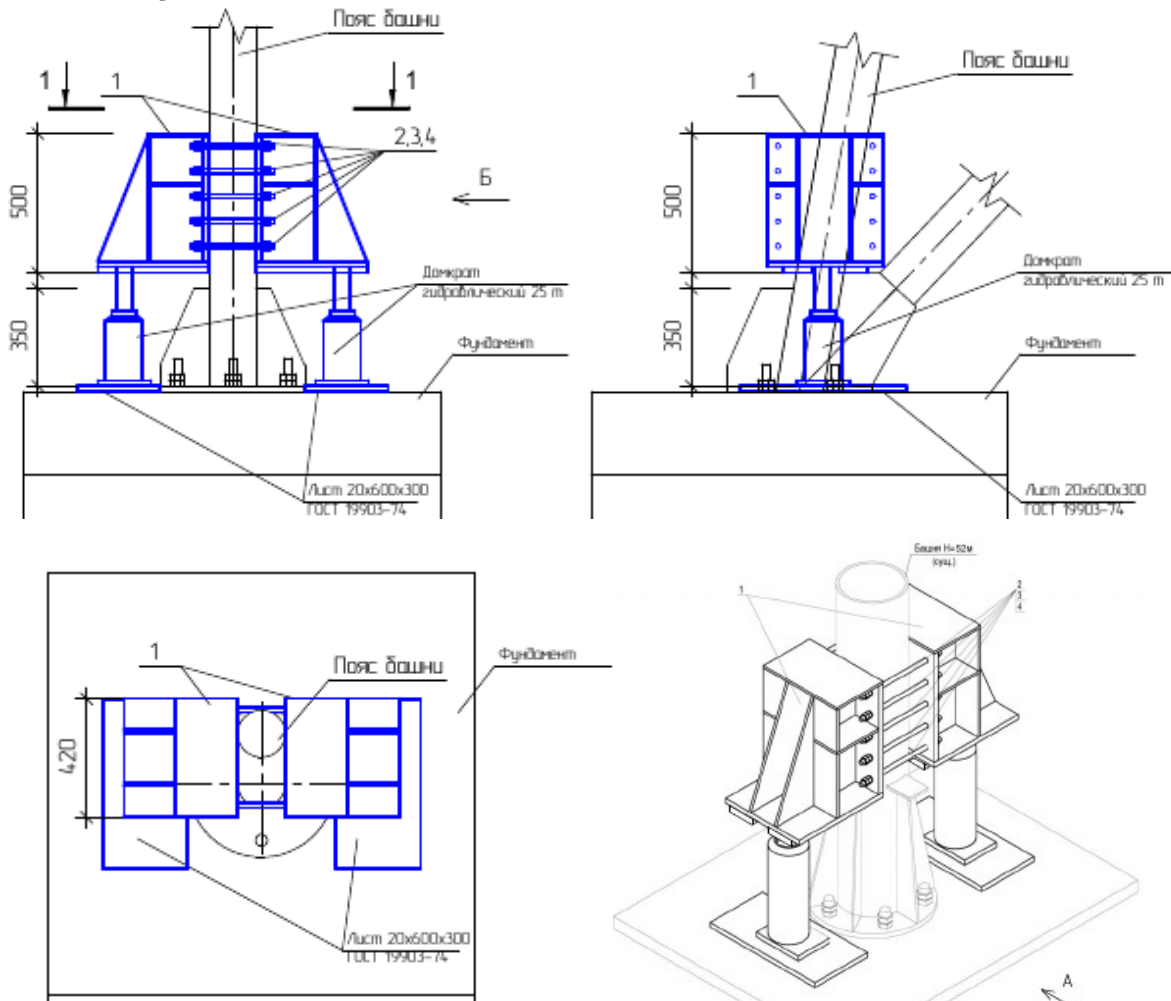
Схема установки домкратов на опорную конструкцию в местах опирания пояса башни
